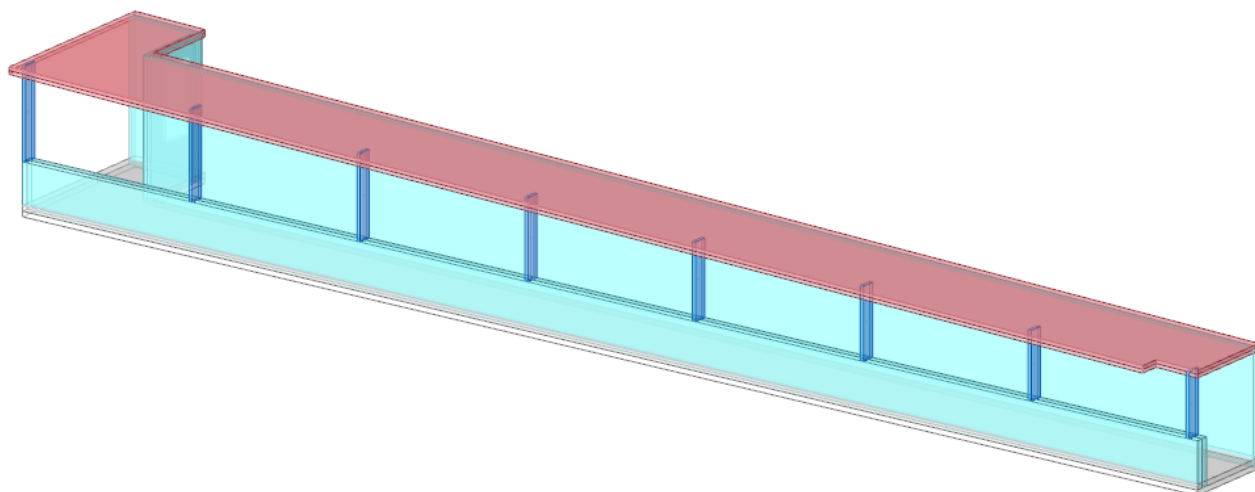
Vista 3D del Modello Strutturale FEM – Corpo B – Vista Assonometrica – Stato di Progetto
